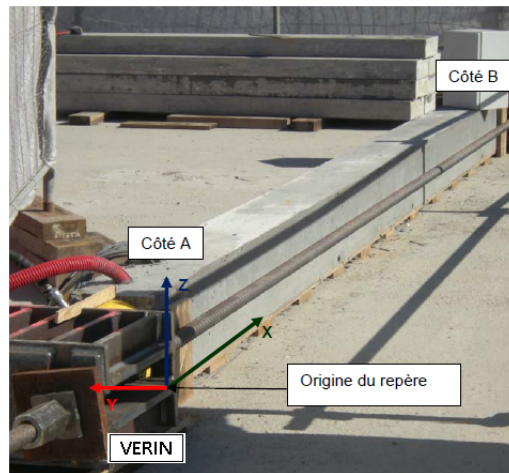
Position et orientation du repère de la poutre d'essai.
